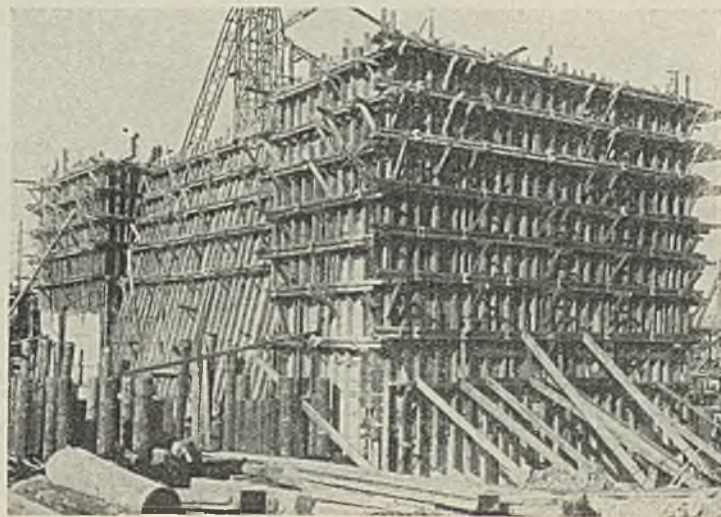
Außenhaupt. Westliches Toranschlagbauwerk, Schalung.
